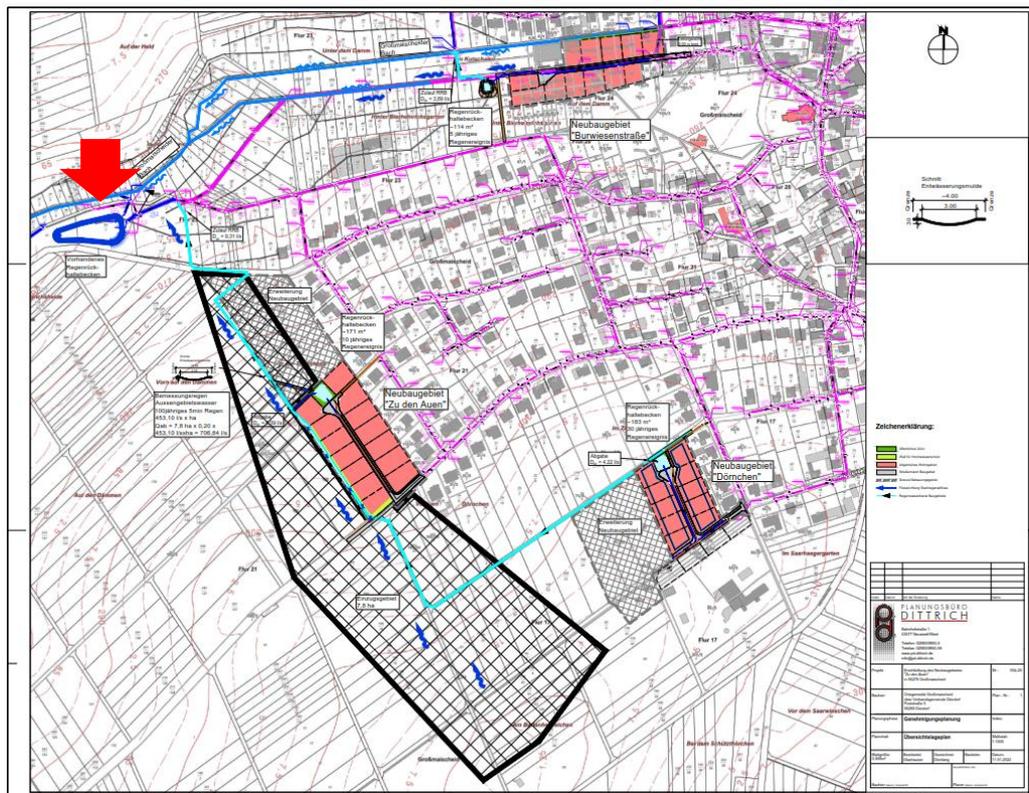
Lageplan mit Kennzeichnung des RRB „Großmaiseid“ (roter Pfeil)
